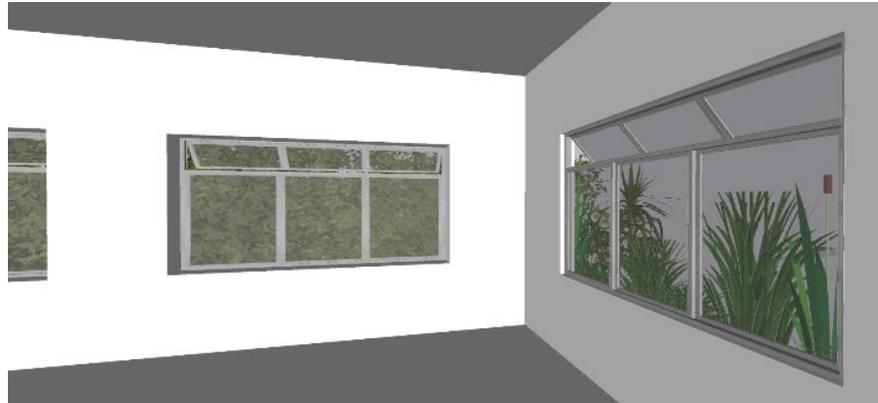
PLANO JARDINERAS EN FACHADAS.
